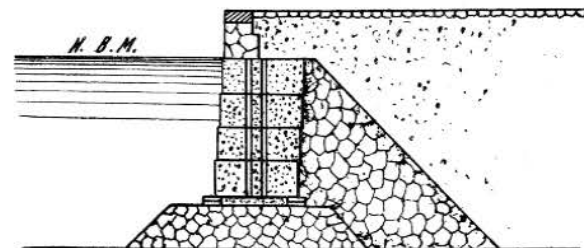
ª.—Puerto de Málaga. Sección del muelle.
